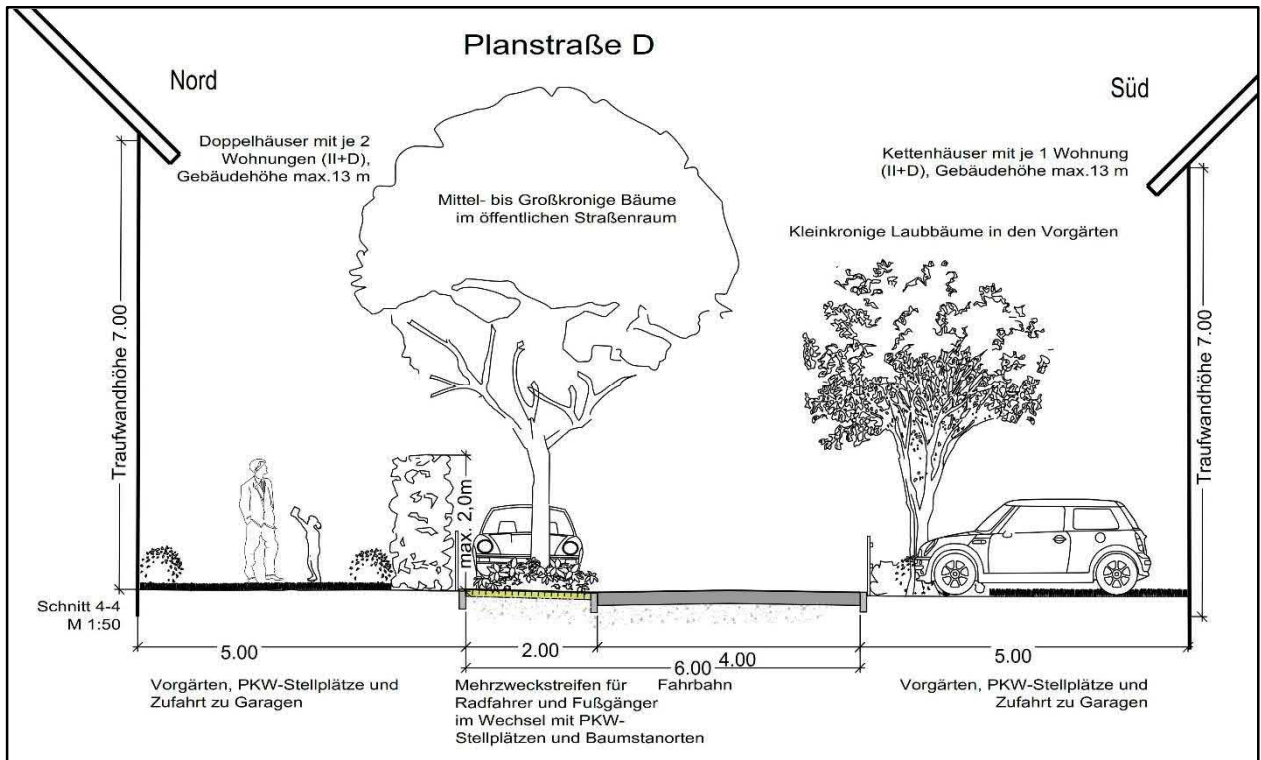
Straßenquerschnitt 6 m (Planstraße D)
